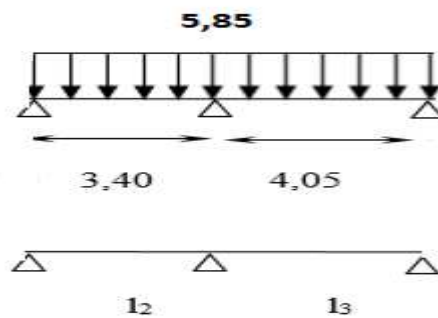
chargement du 3^{ème} type de poutrelles
